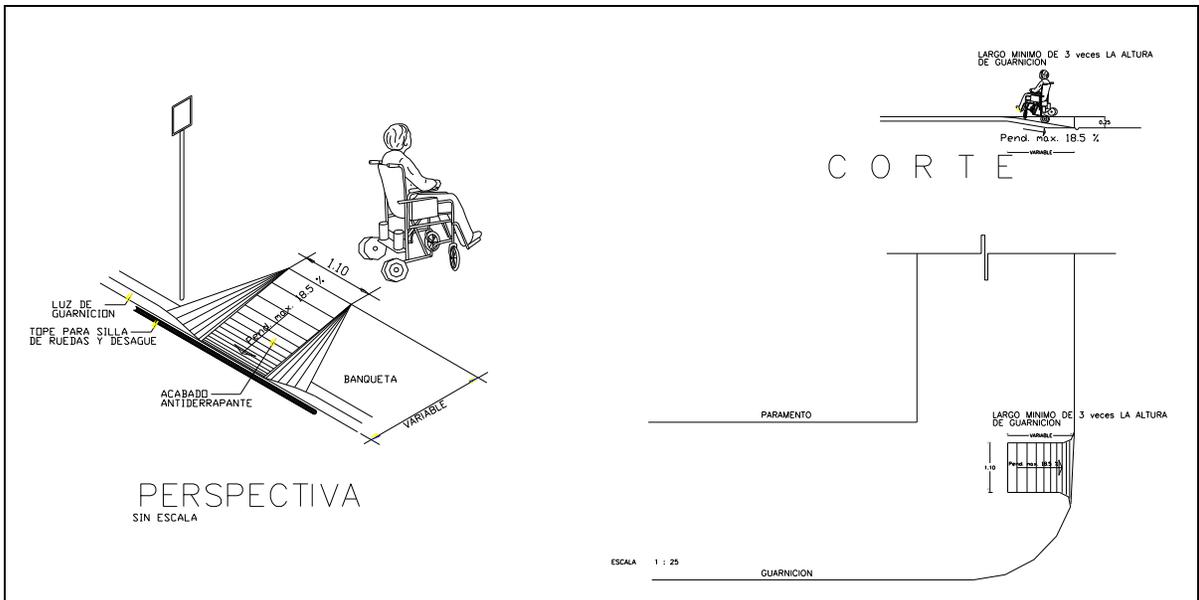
(RD) Rampa para discapacitados. Planta y Detalle
